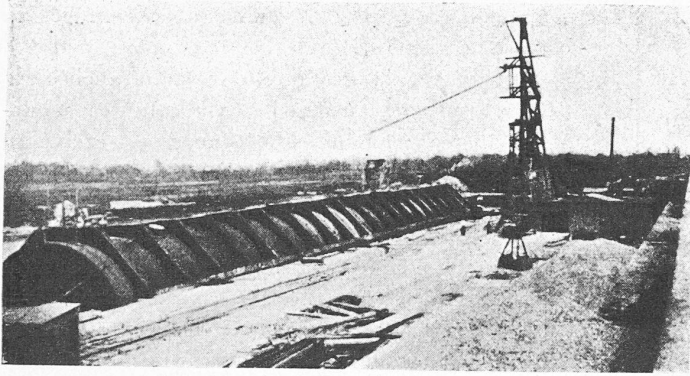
Tunnel à Déroit. — Bétonnage intérieur.
